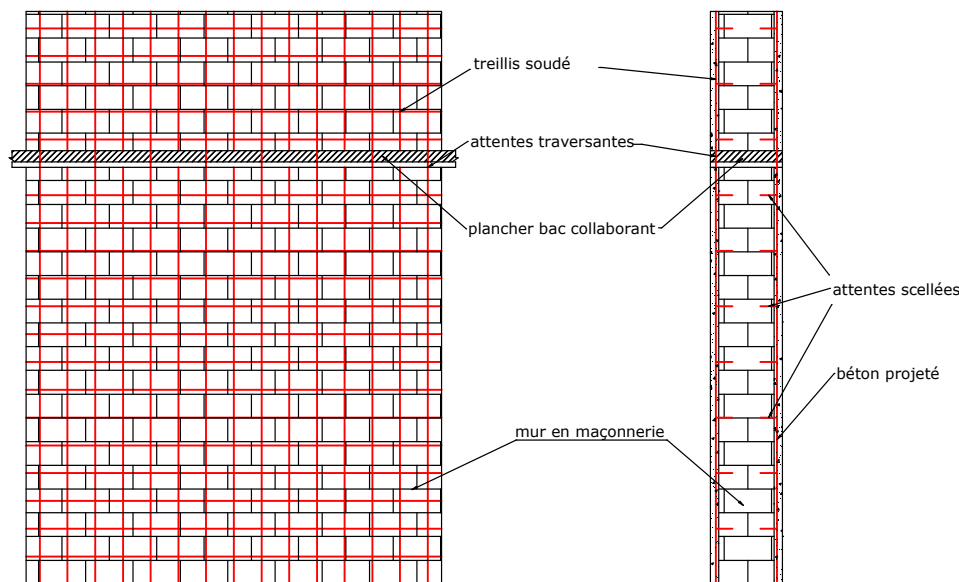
Illustration d'un mur (40 cm x 3 m x 3 m) à renforcer
